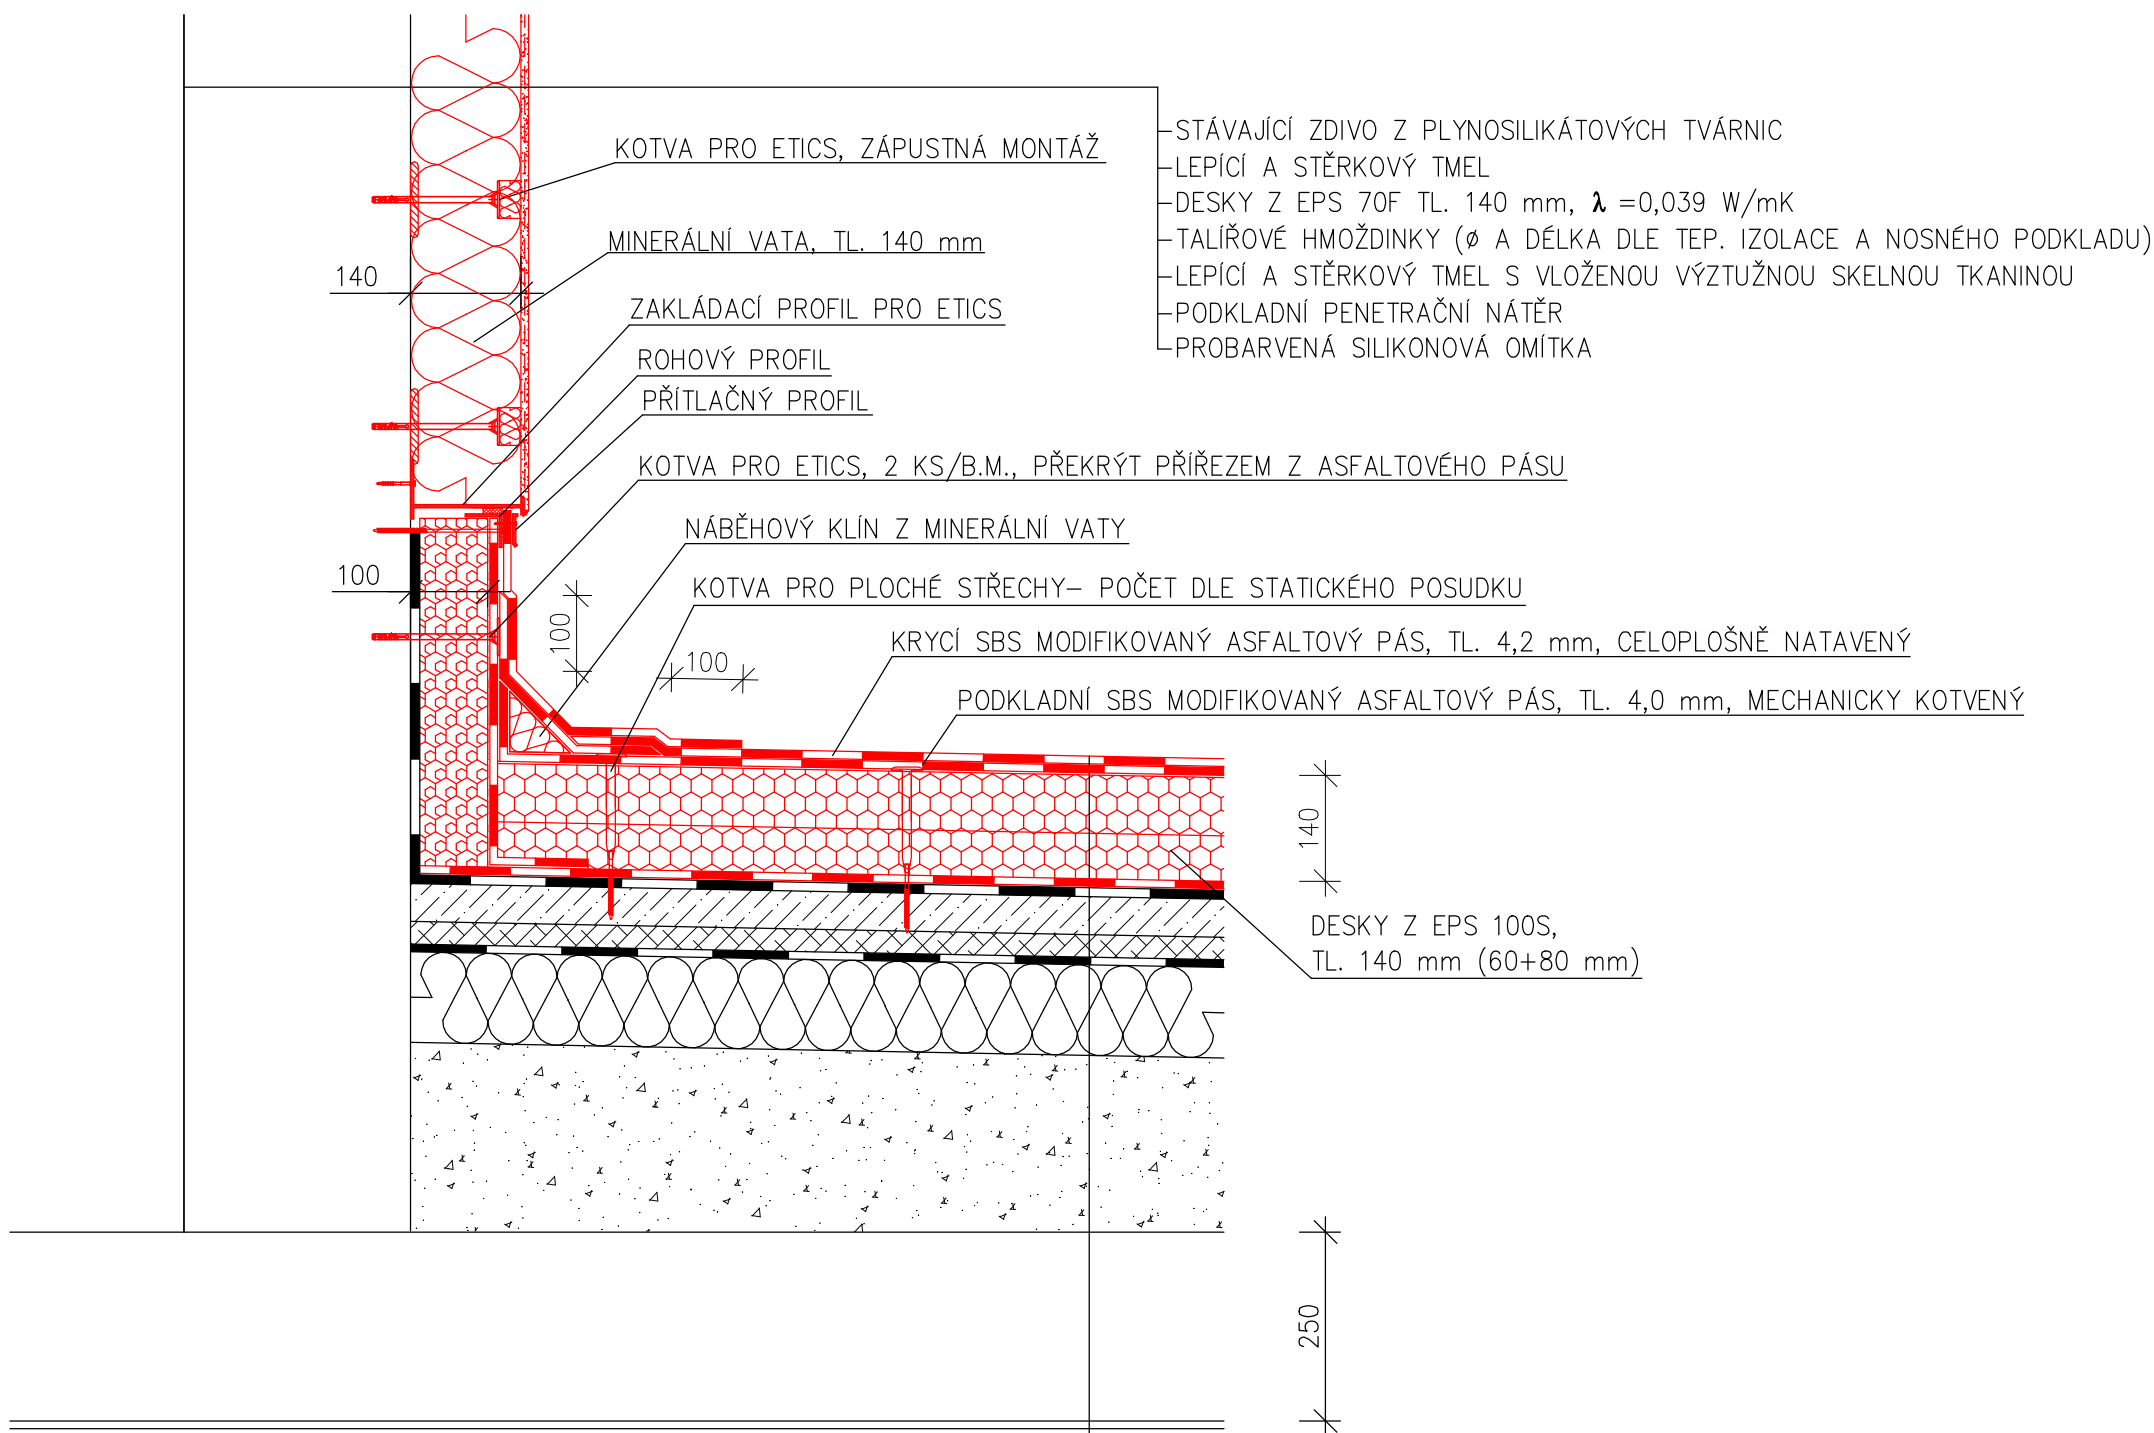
DETAIL E – UKONČENÍ HYDROIZOLACE U STĚNY SE ZAKLÁDACÍ LIŠTOU 1:10
